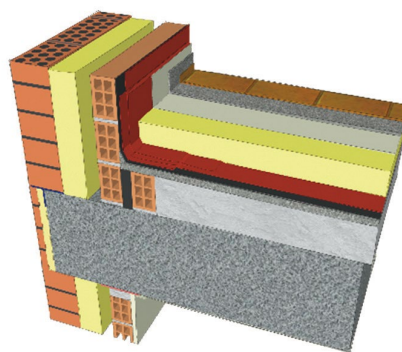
Utilización de aislamientos por exterior en la zona de influencia del puente térmico.
